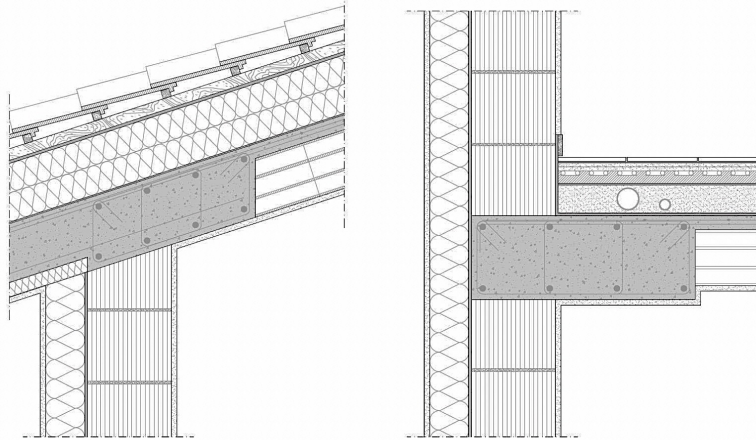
Stratigrafie copertura-parete e orizzontamento- parete dell'edificio 1
